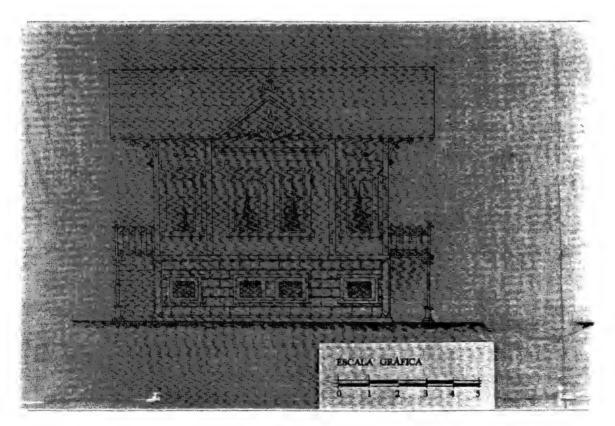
Projeto para a construção de uma casa no Boulevard Castro Alves, em Ondina, em 1896, de autoria do Eng<sup>o</sup> João Pimenta Bastos. Fachada Principal.
